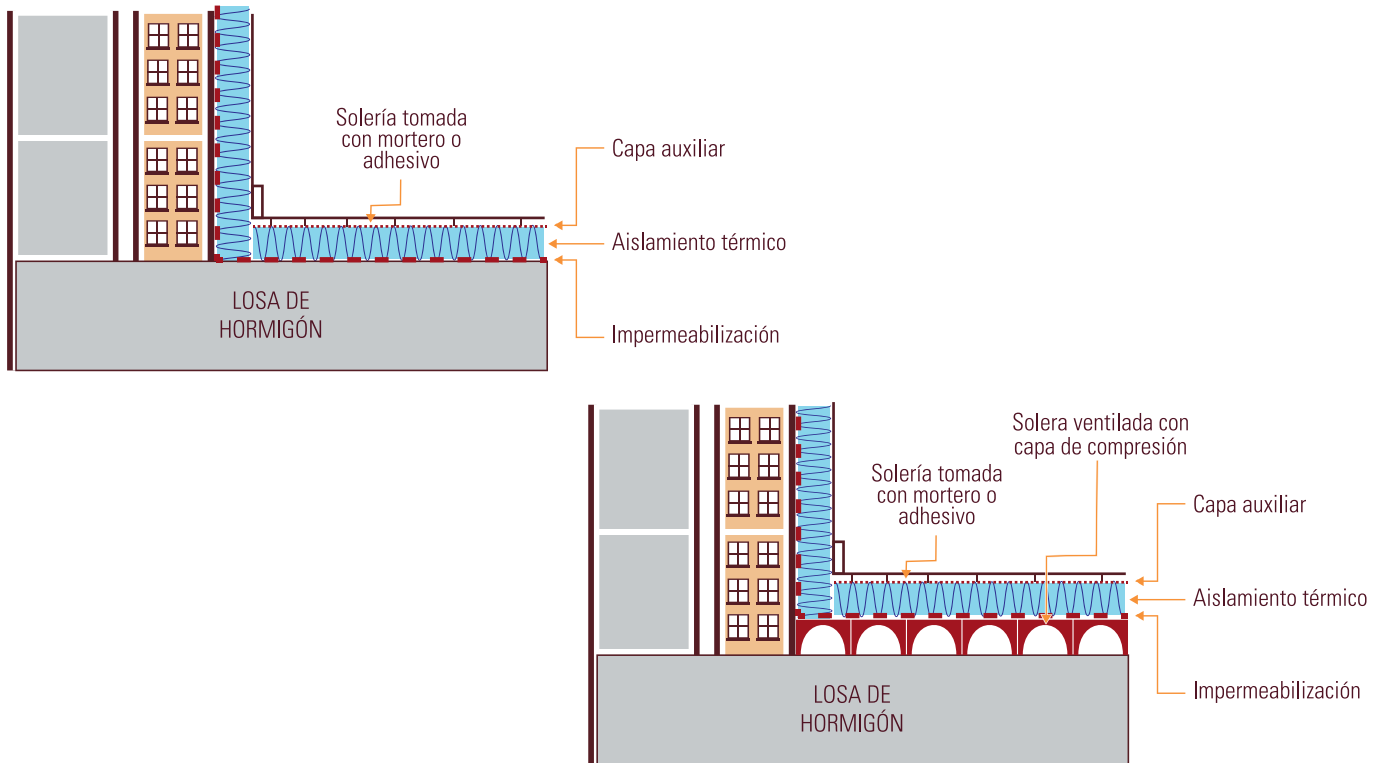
Mejora del aislamiento en losa de cimentación mediante solera ventilada
